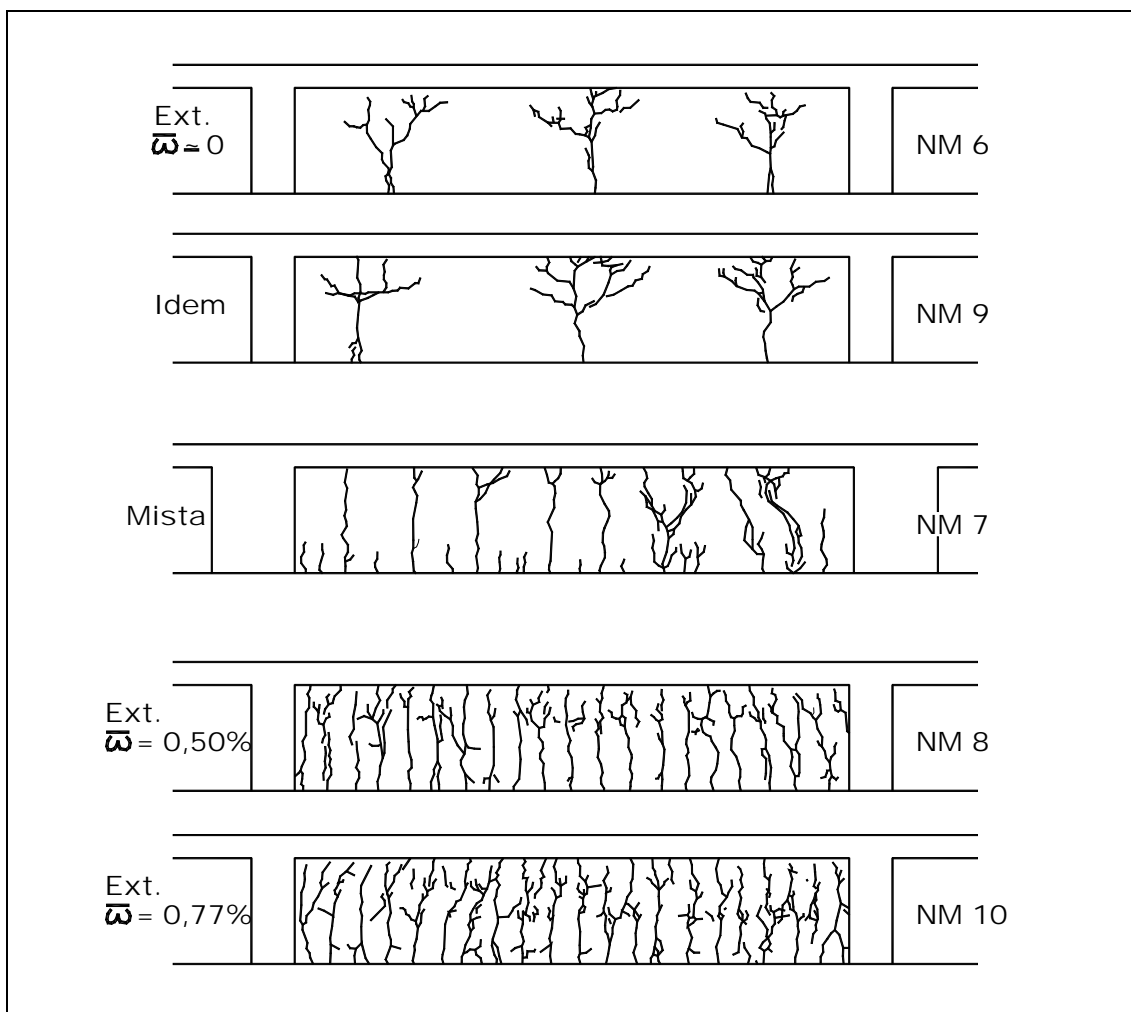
Estado de fissuração das vigas monolíticas com variadas taxas de armadura
